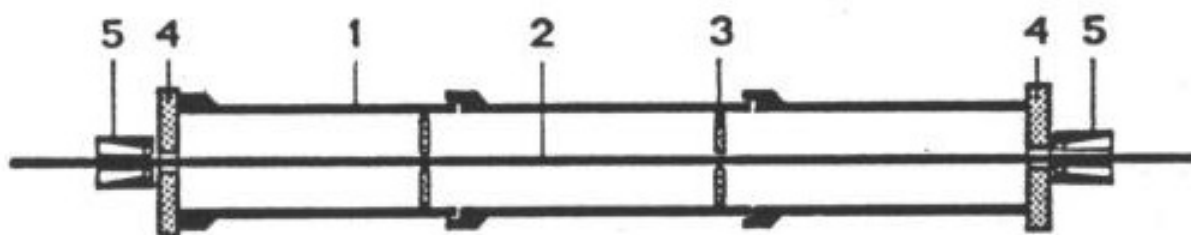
Cabo de compressão comprimido segundo Billig [2].
